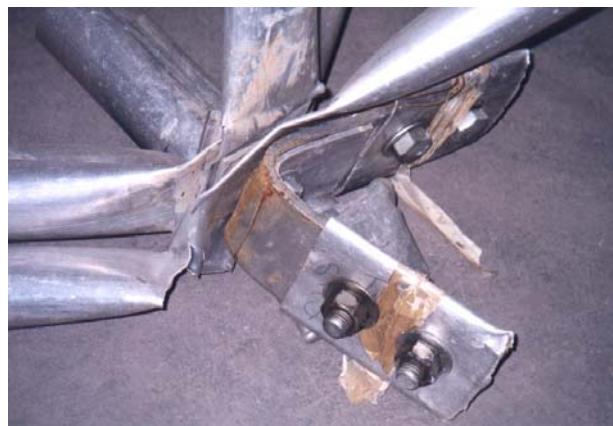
Detalhe da ligação após ruína da estrutura
